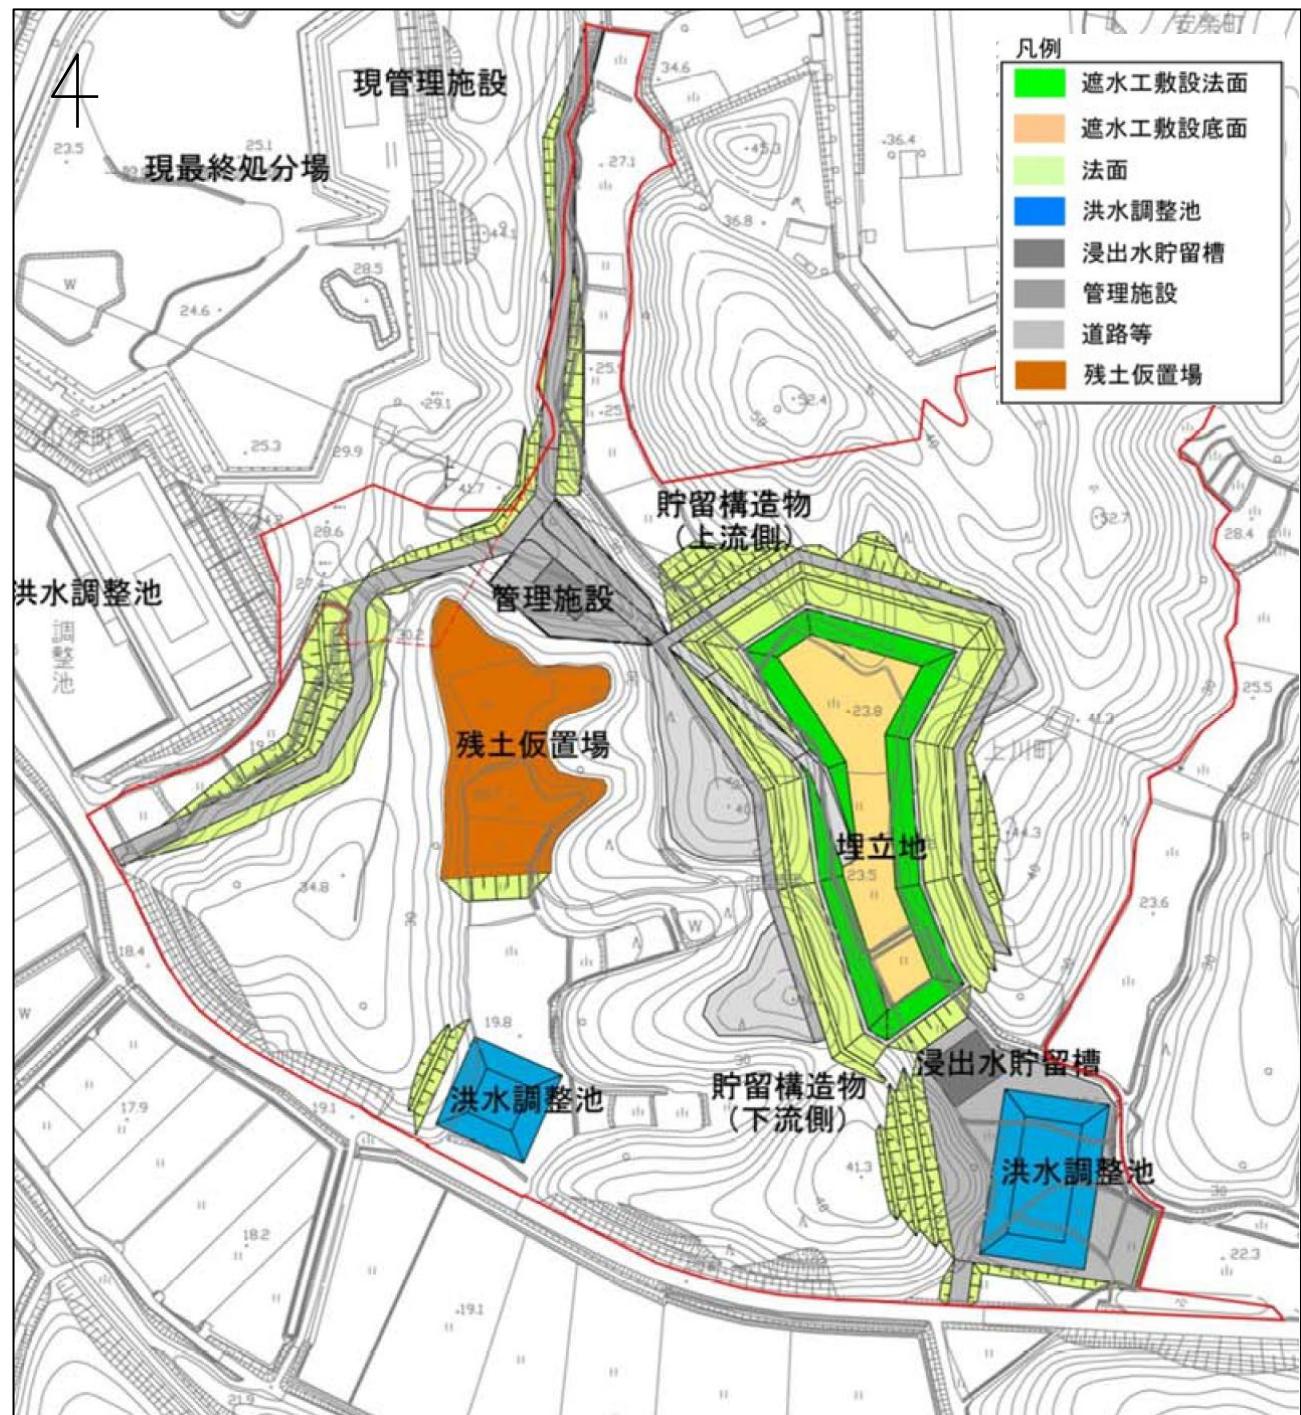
2(1) 新最終処分場配置平面図（方法書段階第1期）
